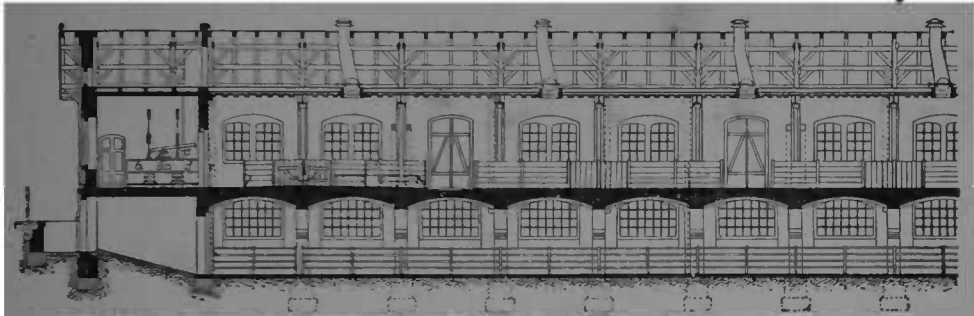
Coupe longitudinale de la halle aux veaux du marché de Berlin, surmontant une bergerie
